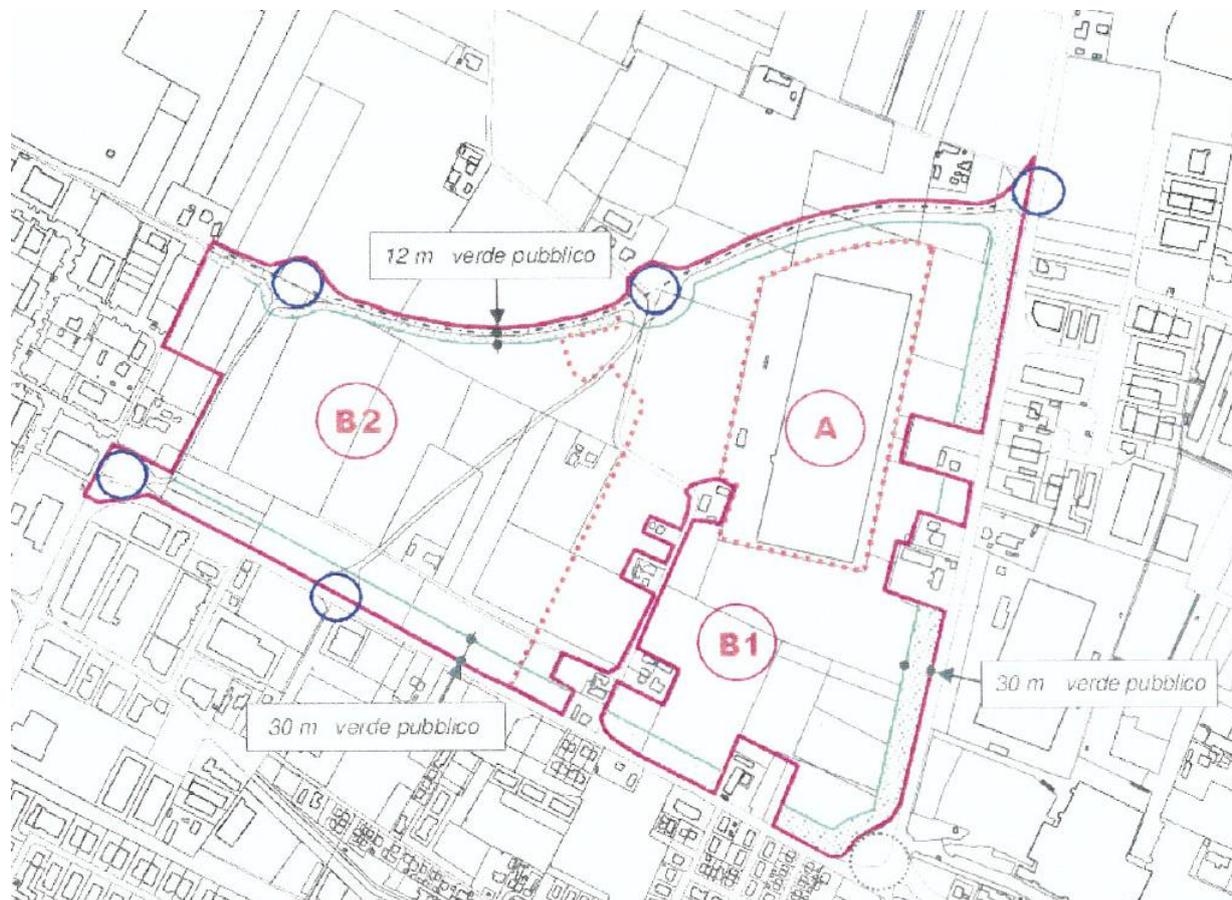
Immagine planivolumetrica della rete stradale di progetto Comparti A+B1+B2.
